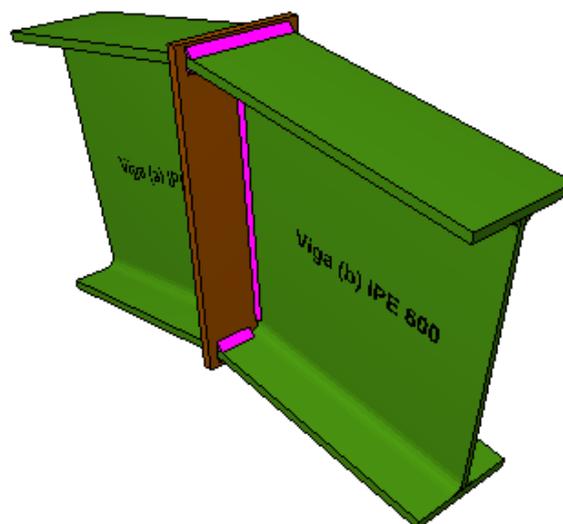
Soldadura S4. Fuente: CYPE 2017
